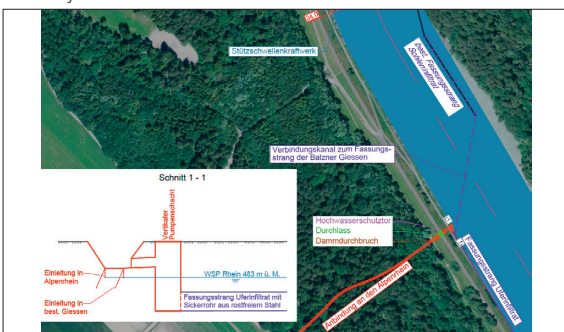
Situationsplan und prinzipieller Schnitt durch den Fassungsstrang für Uferinfiltrat
